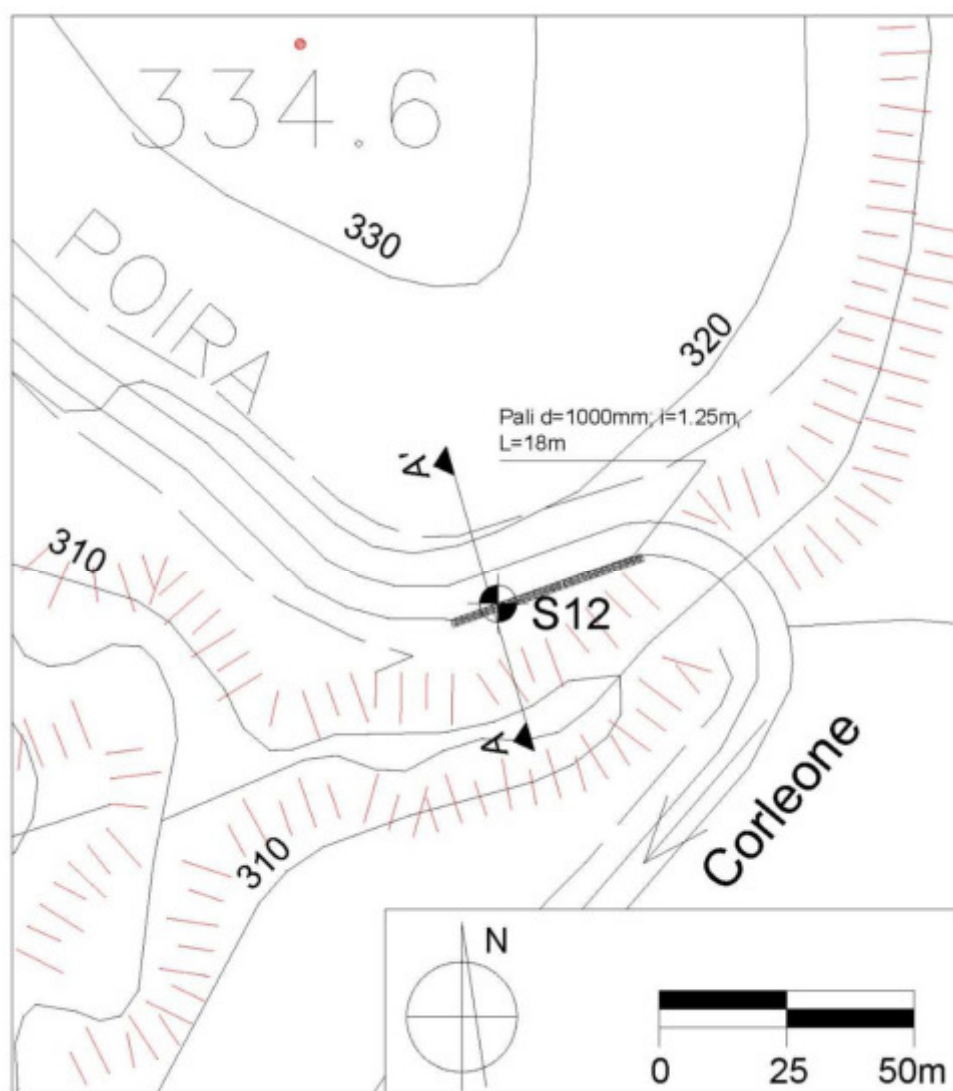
Dissesto al km 18+400. Planimetria schematica degli interventi da realizzare.
